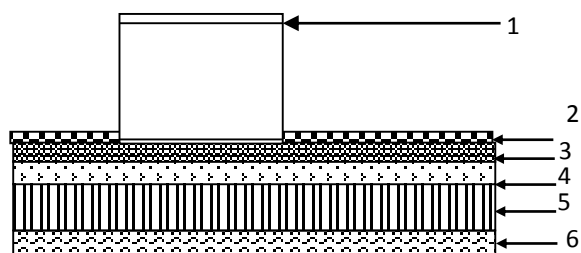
Coupe transversale du plancher terrasse inaccessible
